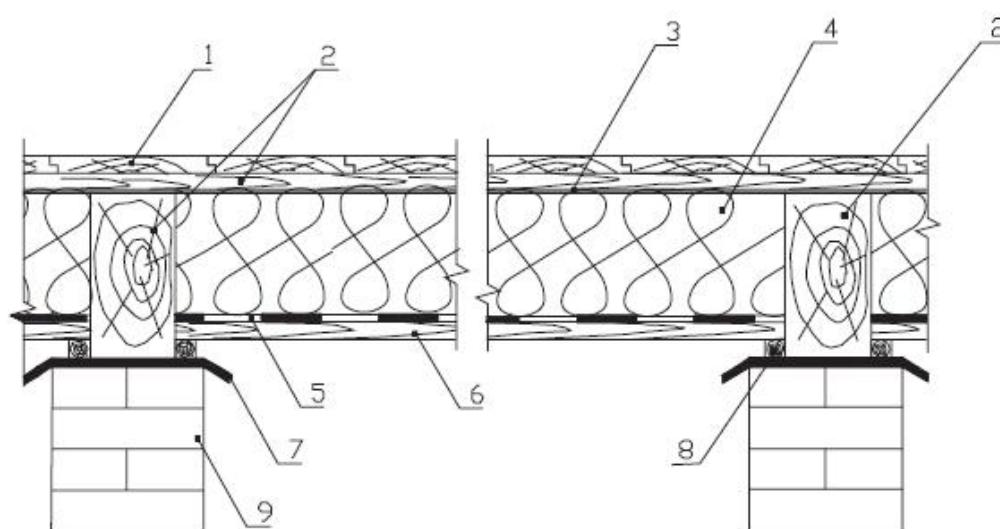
Чердачное перекрытие неутепленной мансарды или холодного чердака с теплоизоляцией из плит марки "ТЕРМОЛАЙТ", "ТЕРМОЛАЙТ+", "ТЕРМОСТЕНА", "ТЕРМОСТЕНА+", "ТЕРМОВЕНТ"
